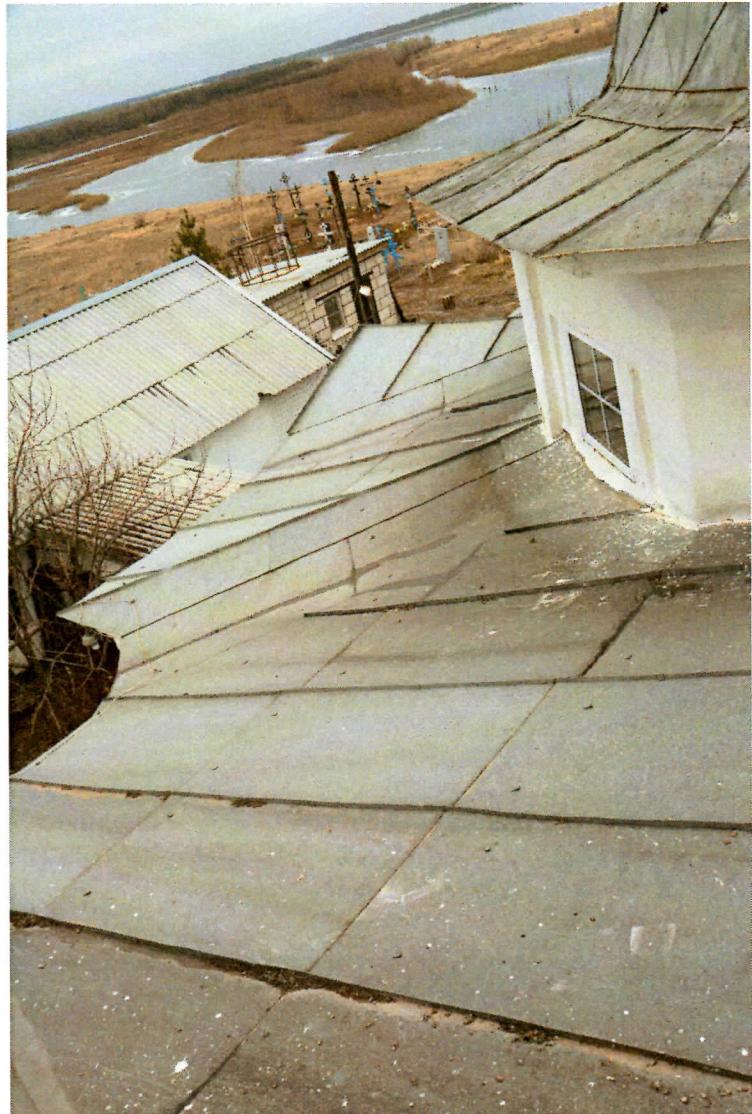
Кровля. Стальное фальцевое покрытие над боковыми приделами
